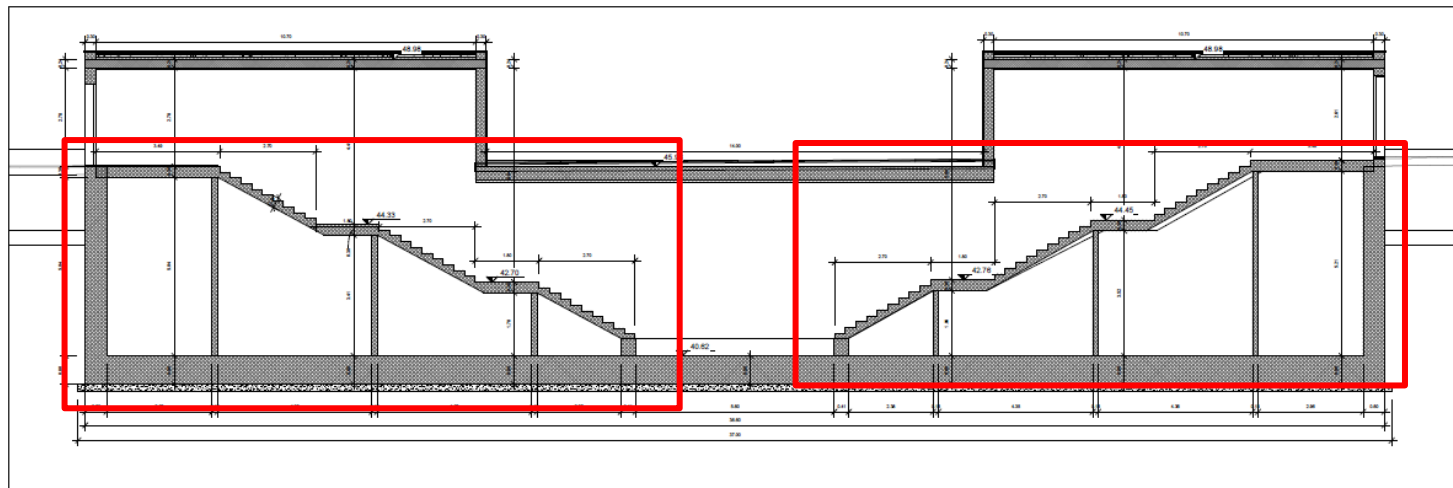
Sezione longitudinale dell'opera con individuazione dei vani scale
